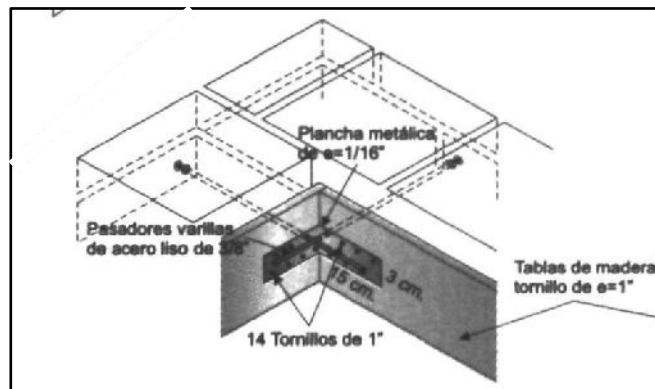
Detalle B: Refuerzo metálico interior (Kuroiwa, 2002)
